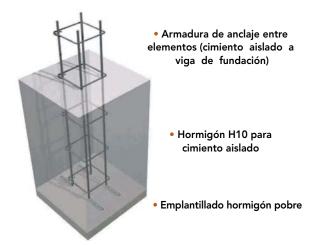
11: Pilote de hormigón de sección rectangular, la profundidad del sello de fundación, armaduras y especificaciones, deben ser corroboradas por cálculo estructural.
